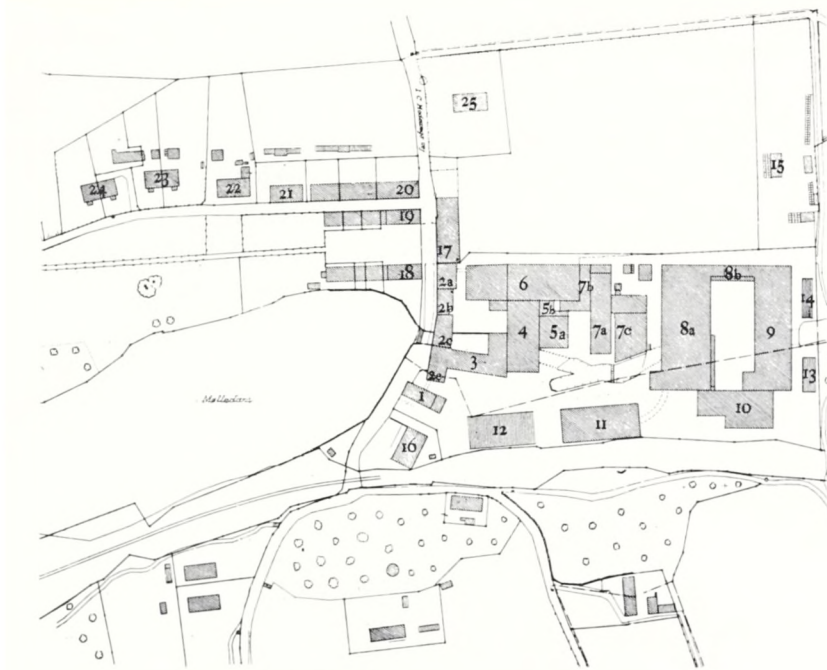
Plan over Brede værk. Målestok ca. 1 : 2500.
